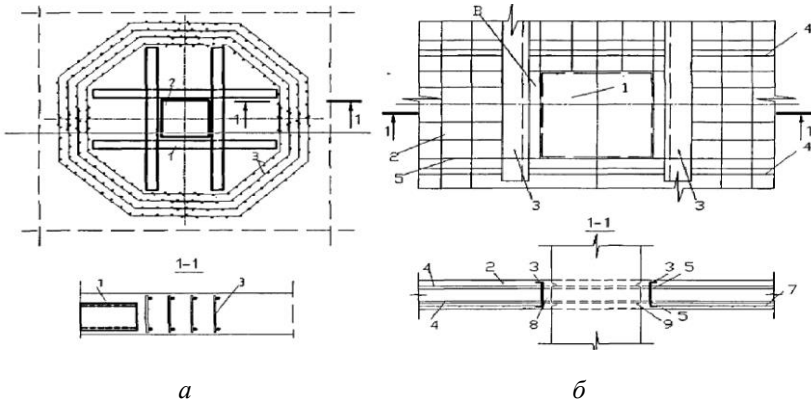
Армування вузлового з'єднання «плита–колона» жорсткою арматурою швеллерами:
